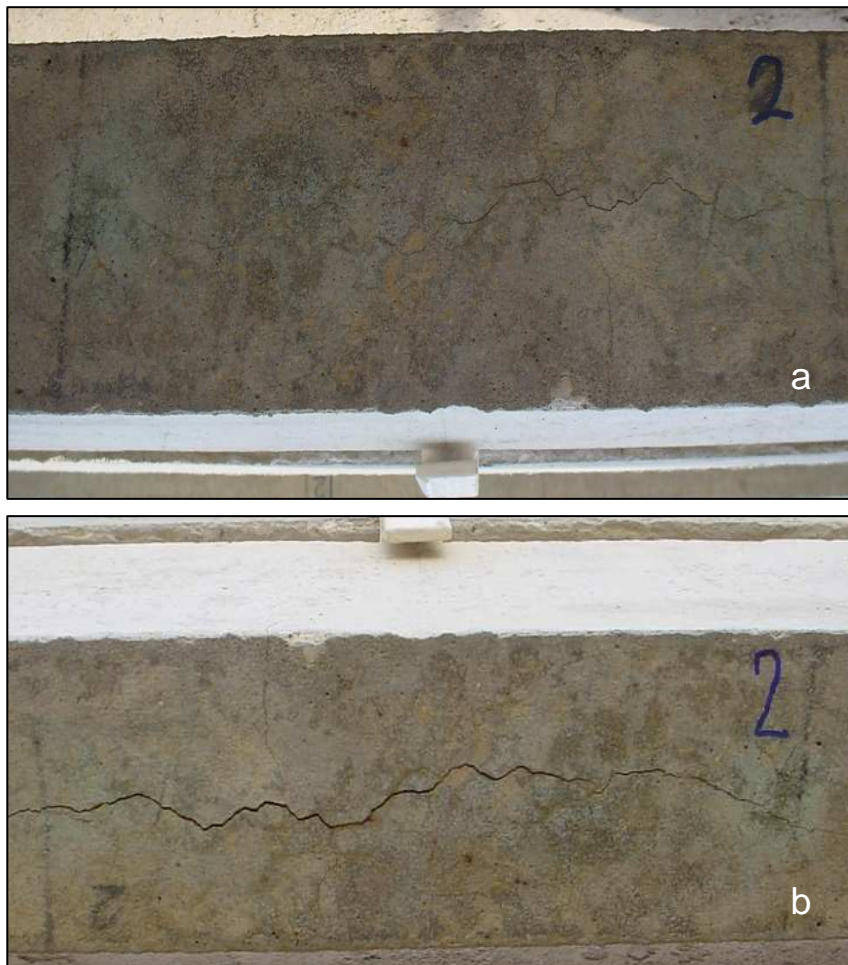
Fisuras observadas en la viga 2.
